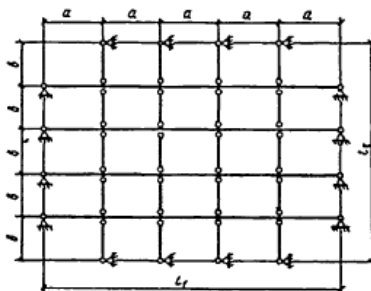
Разбивка покрытия на главные и второстепенные балки
